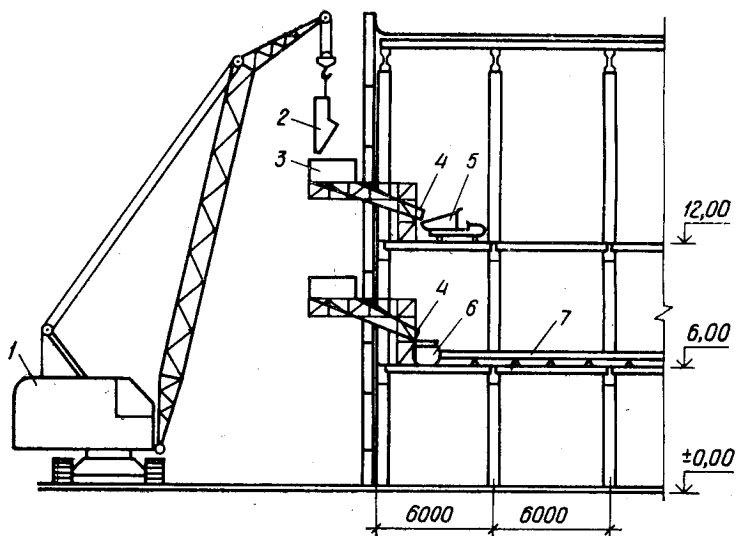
Подача бетонной смеси при выполнении работ в многоэтажном здании:
